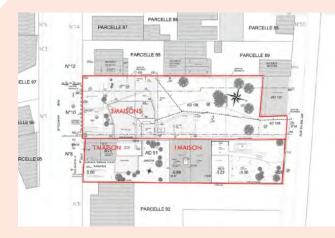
Plan du projet, Pantin, Atelier Philippe Tirot
